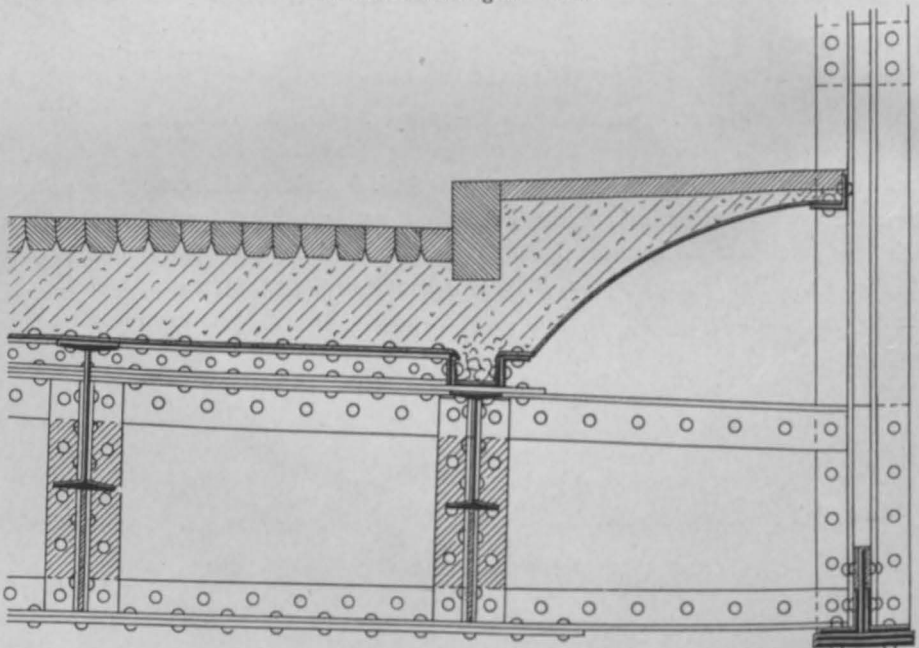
Dichte (aus glattem Bleche gebildete) Fahrbahntafel einer Straßenbrücke. 1 : 20.
